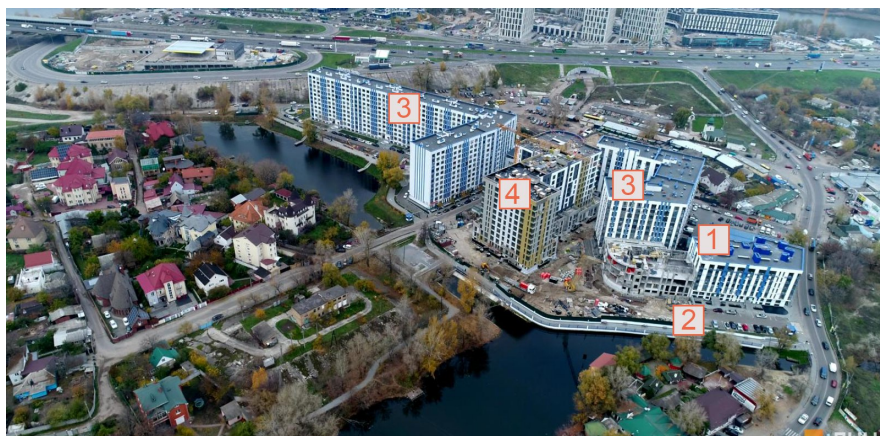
року, цифрами позначено: 1. Будинок, побудований без дозволів у прибережній захисній смузі, 2. Парковка, як і будинок збудована на землі, що не надана у власність чи користування 3. Будинки, які мали бути чотириповерхові, 4. Будинок збудований на земельній ділянці без отримання містобудівних умов і обмежень.
